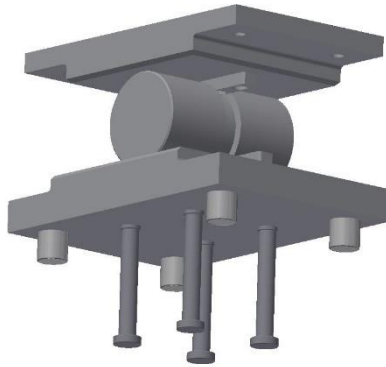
Lagertyp Re,L, oben Stahl & unten Betonanschluss.
